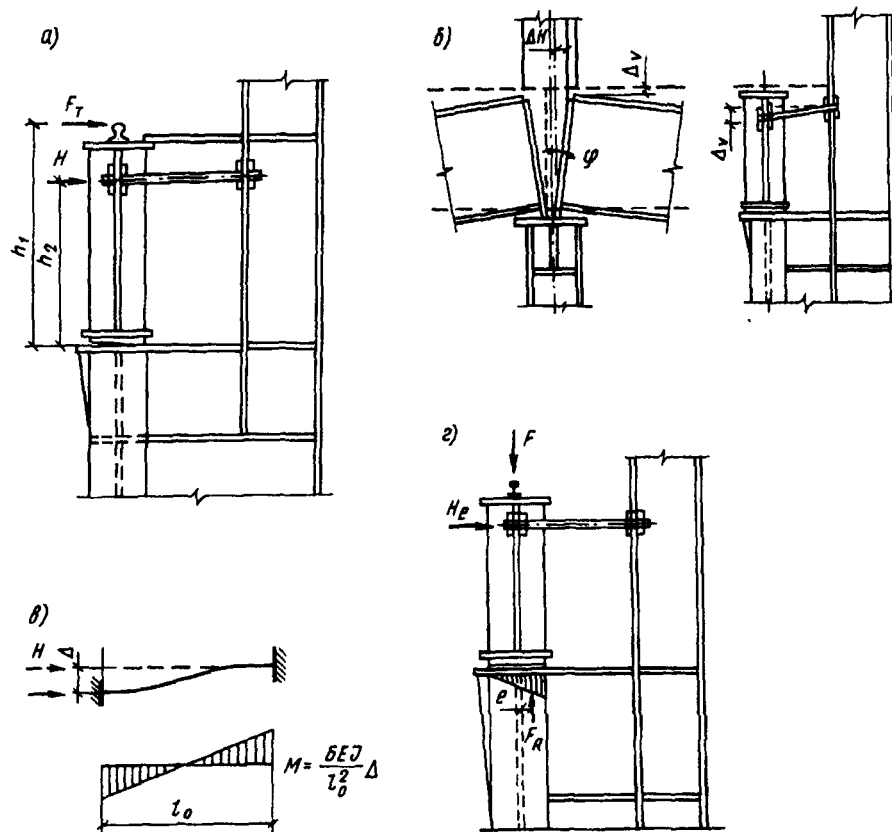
К расчету узла крепления подкрановых балок к колонне
